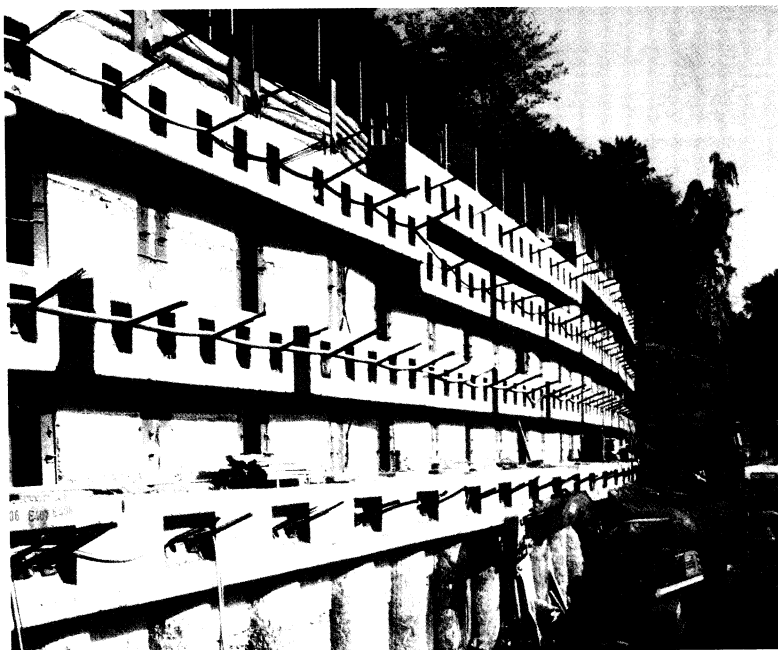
Budowa płytkiego tunelu w wykopie z tymczasowym zabezpieczeniem prefabrykowanymi ścianami oporowymi, kotwionymi do gruntu – kotwy BBR CONA (Adlertunnel, Szwajcaria)
